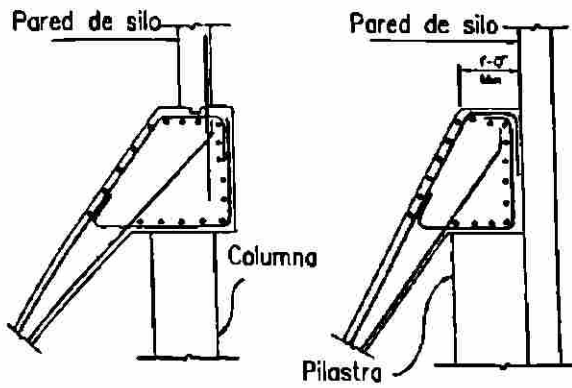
Detalles típicos de viga de soporte de tolva.
